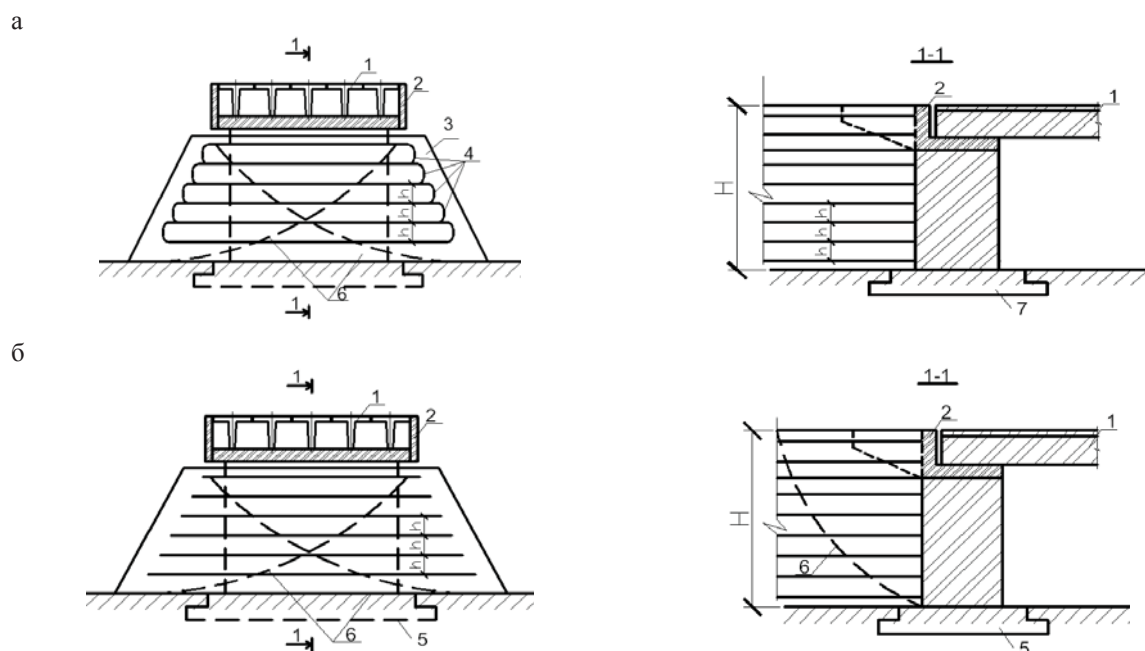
Схема армирования мостового перехода с массивным устоем (подпорная стенка): а – несвязные грунты; б – связные грунты; 1 – пролетное строение; 2 – массивная опора; 3 – откос насыпи; 4 – армирующие полотнища; 5 – фундамент; 6 – наиболее опасные потенциальные поверхности обрушения неармированной насыпи; h – шаг армирования; H – высота армирования грунта.
